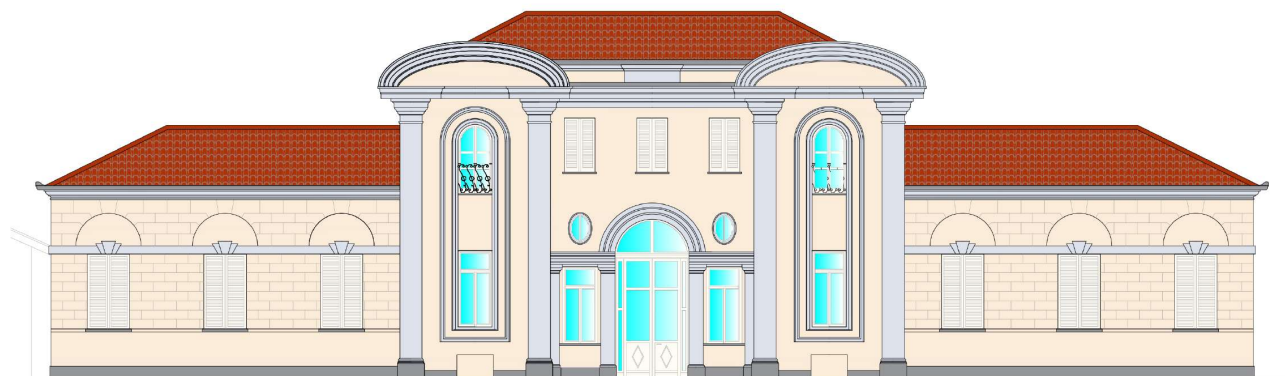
Vista esterna del fabbricato oggetto d'intervento (Prospetto Sud su Via dell'Asilo).
